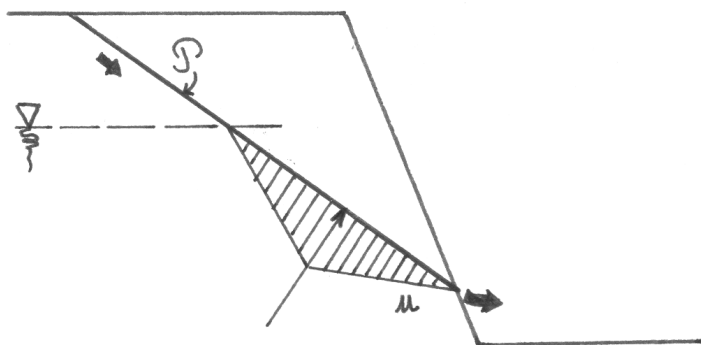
Effet de l'eau sur la stabilité d'un talus. Cas d'un seul plan de discontinuité.
